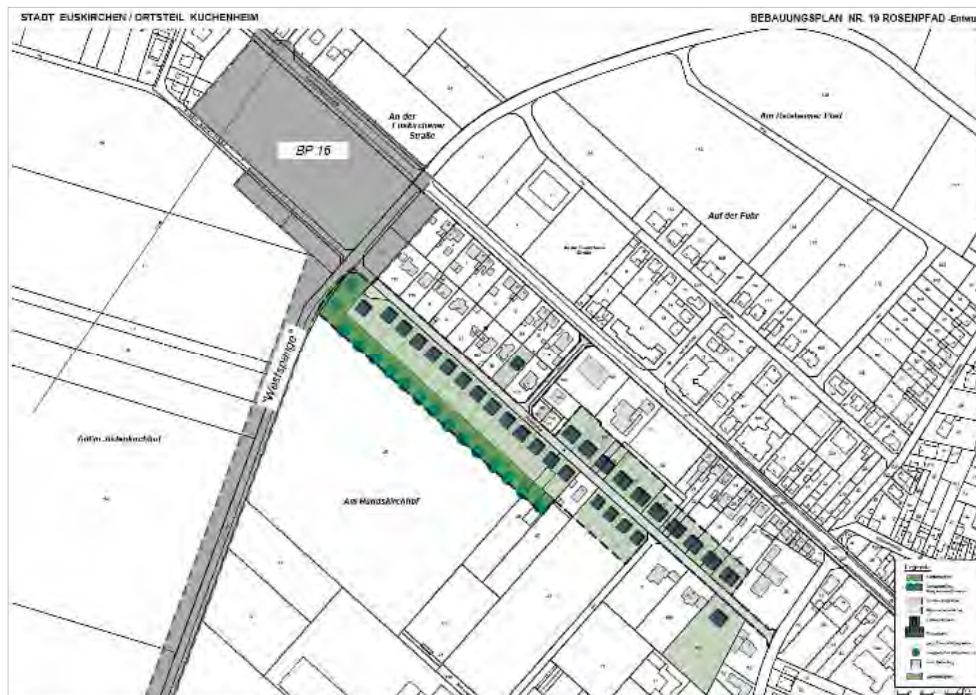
Bebauungsplan Nr. 19 mit nachrichtlicher Darstellung, Bebauungsplan Nr. 16
